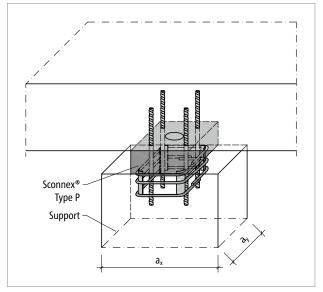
Schöck Sconnex® type P: raccordement pour un poteau rectangulaire; montage centré - dimensions du poteau a_x et a_y cf. page 126
